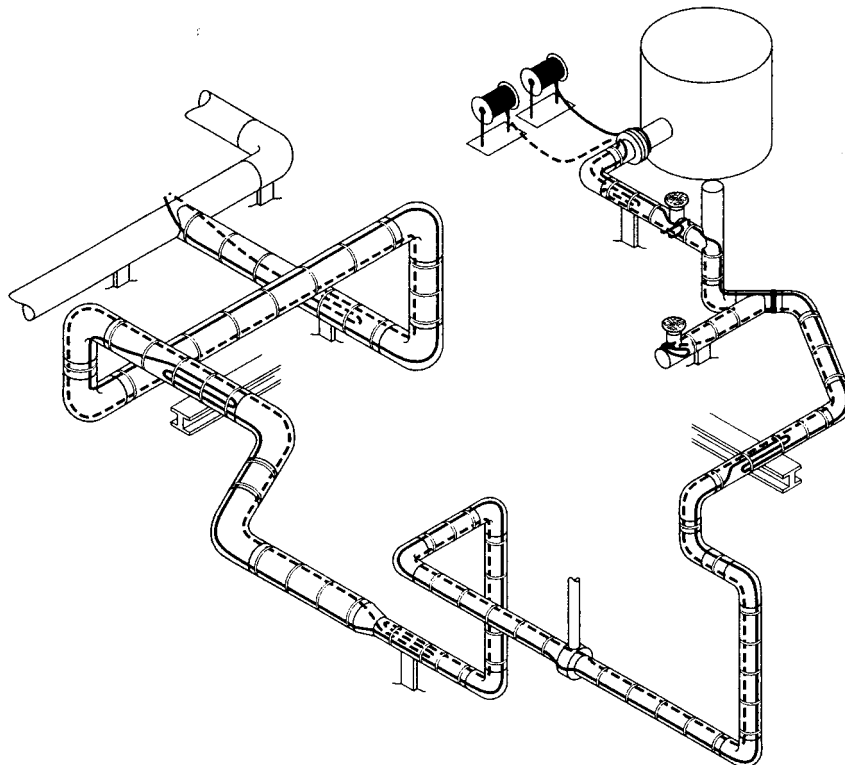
Обогрев трубопровода в две нитки греющего кабеля
